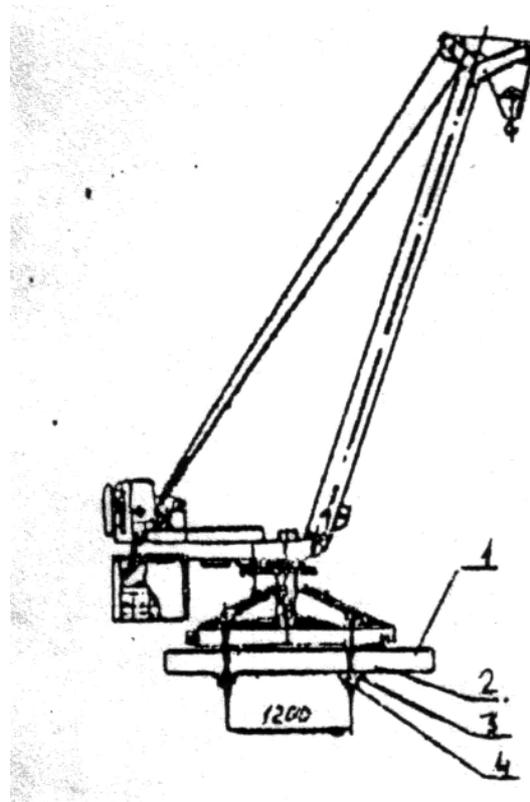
Схема крепления крана на перекрытии строящегося здания.
